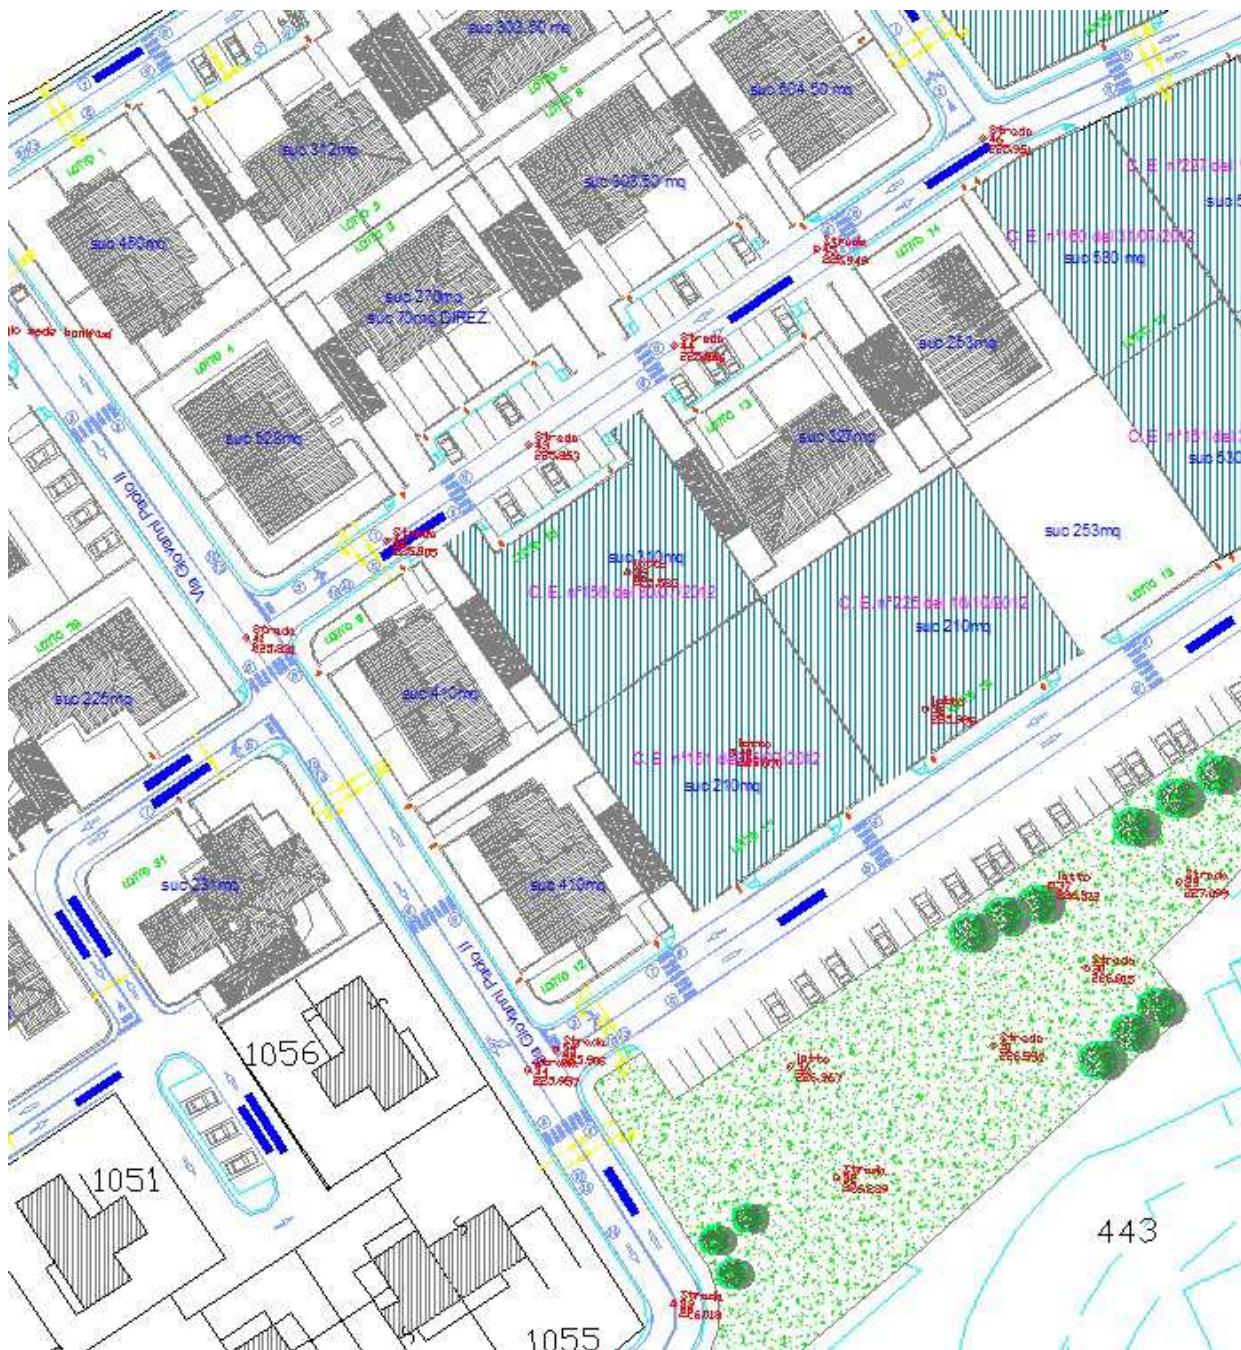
Planimetria generale dello Stato Attuale dei luoghi con inserimento dei punti del rilievo battuto - Zoom B -
